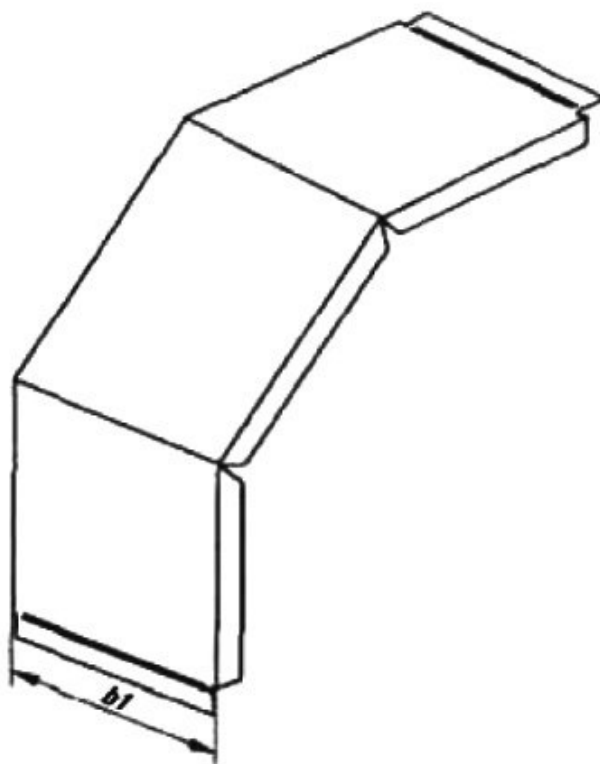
Крышки лотков для поворота трассы вниз под углом 90°
